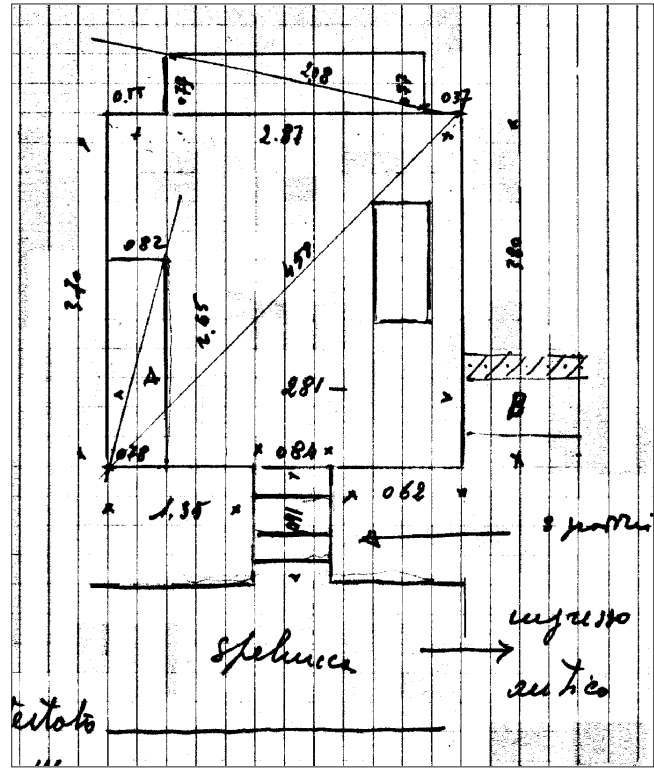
Schizzo planimetrico del cubicolo Ap (da Giornale di scavo).
